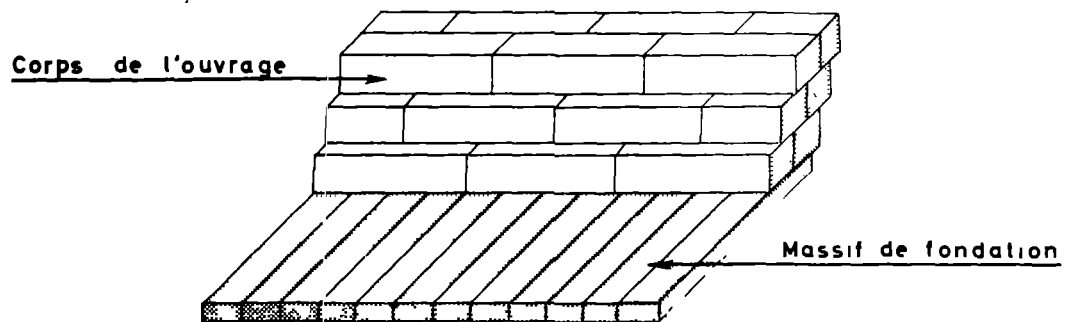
Un ouvrage exclusivement construit en gabions comprend généralement :
